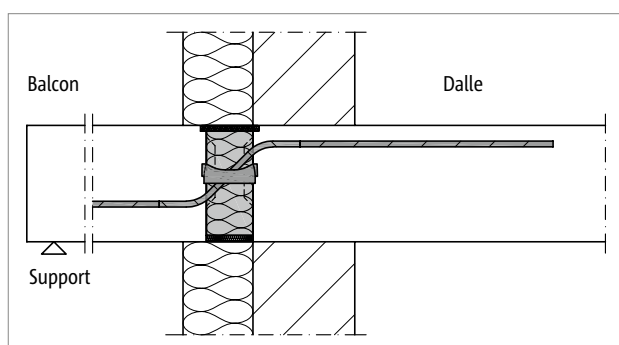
Schöck Isokorb® T Type Q-E : Raccordement pour isolation externe
